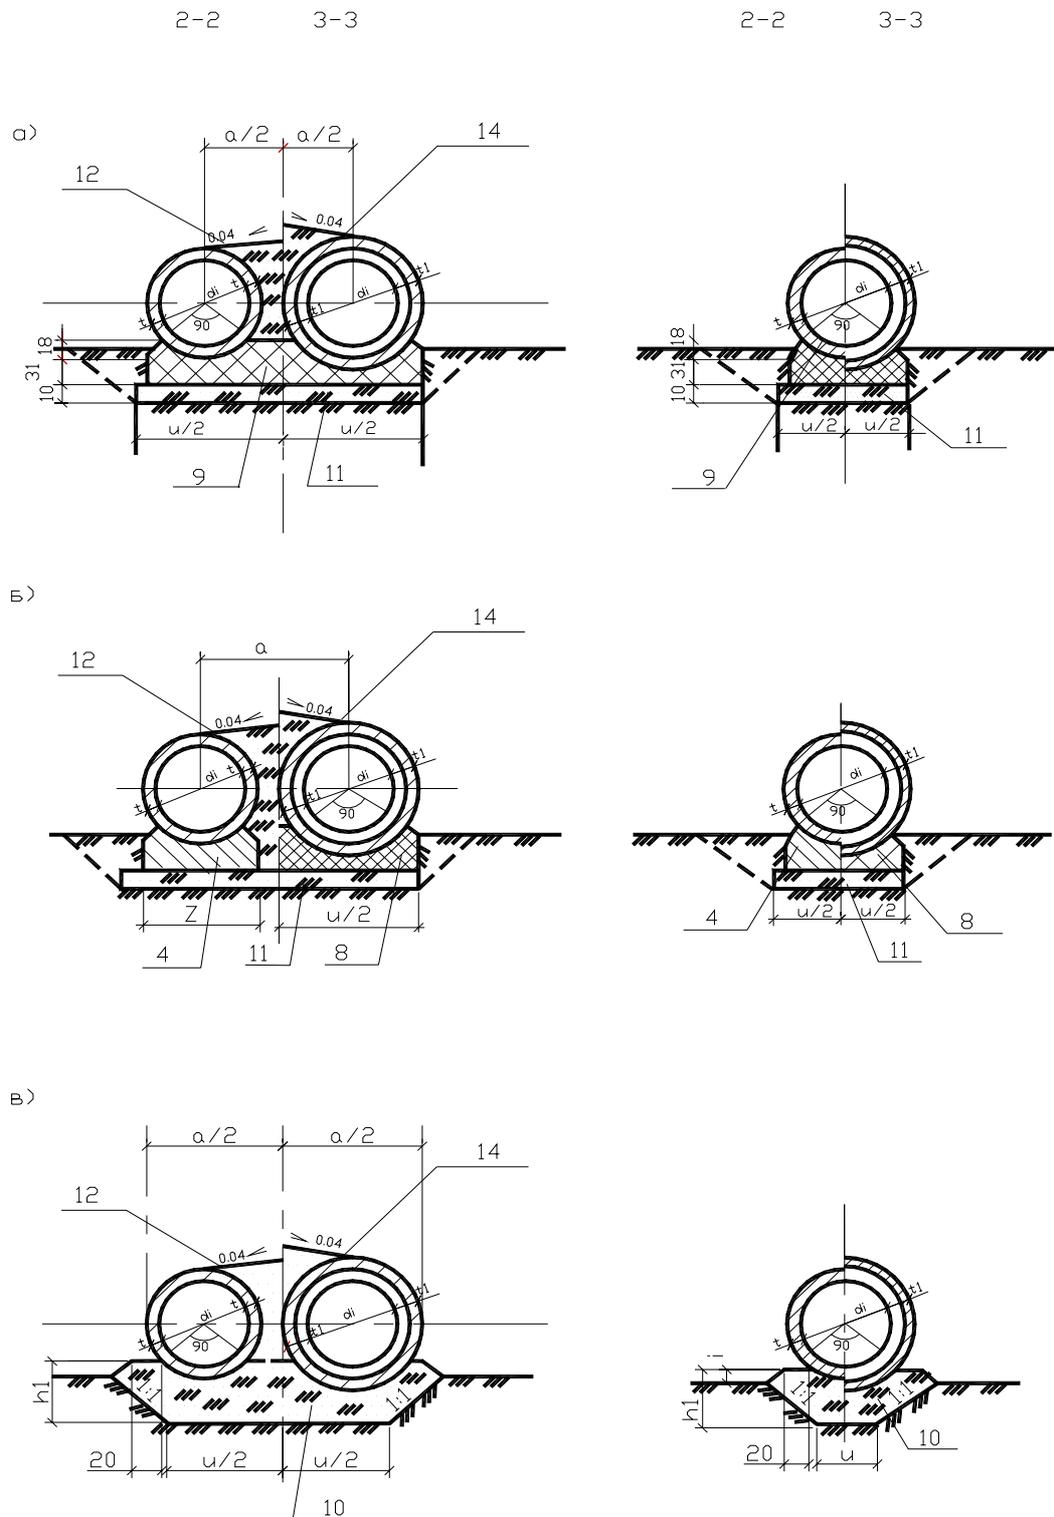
Поперечные сечения: 2-2 и 3-3 (см. рис. 8.2) одно- и двухочковых труб на монолитном (а), сборном (б) фундаментах и на подушке из гравийно-песчаной смеси (в): - бетон В20; 4 - фундаментные блоки; 11 - подготовка из щебня или гравия; 12- заполнение пазух бетоном В 7.5; 14 - гидроизоляция обмазочная ; 8- участок монолитный УМ 3
